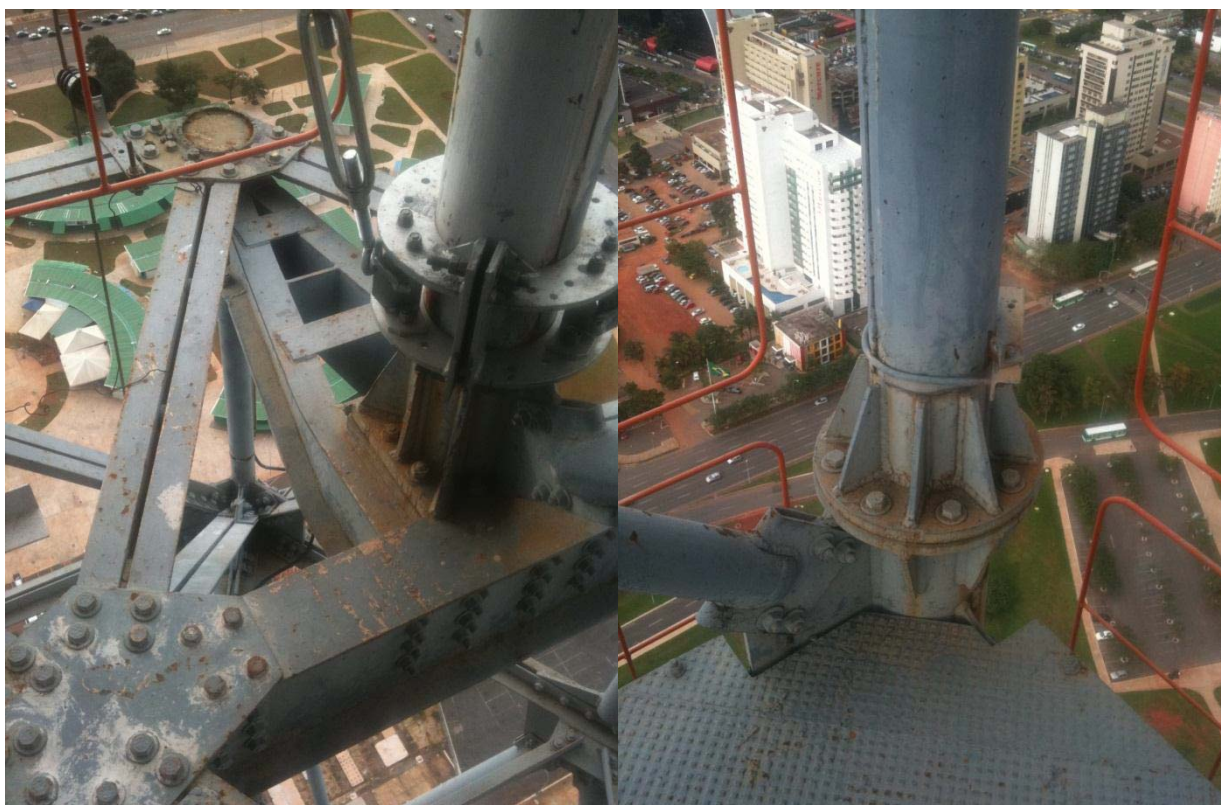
Detalhes do Trecho II (Fonte: Autor)
